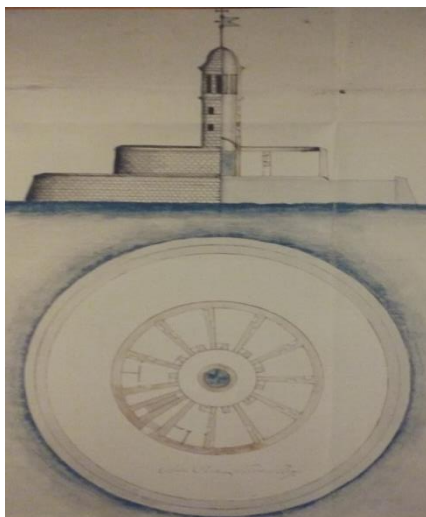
Alçado e planta do projecto traçado pelo arquitecto Mateus de Couto para o Forte do Bugio, 1693, adaptado de (Boiça & Barros, 2004)
